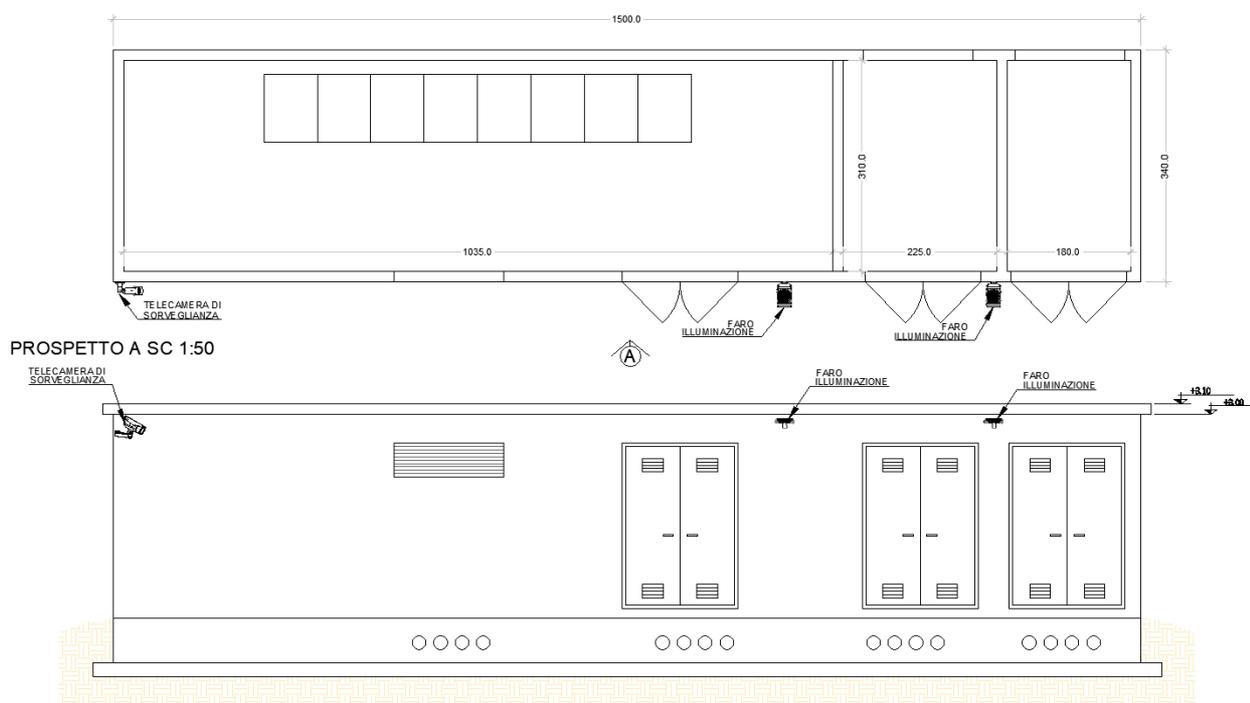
Planimetria e prospetti cabina generale MT con illuminazione e videosorveglianza
